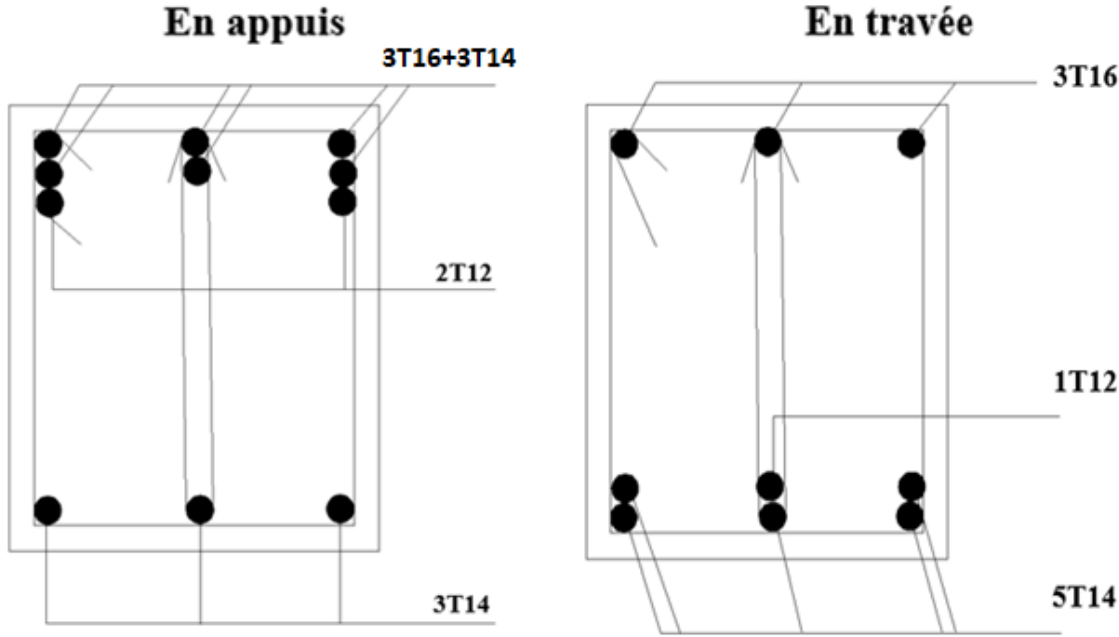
Schéma de ferrailage de la poutre secondaire (35 x 30) cm².
